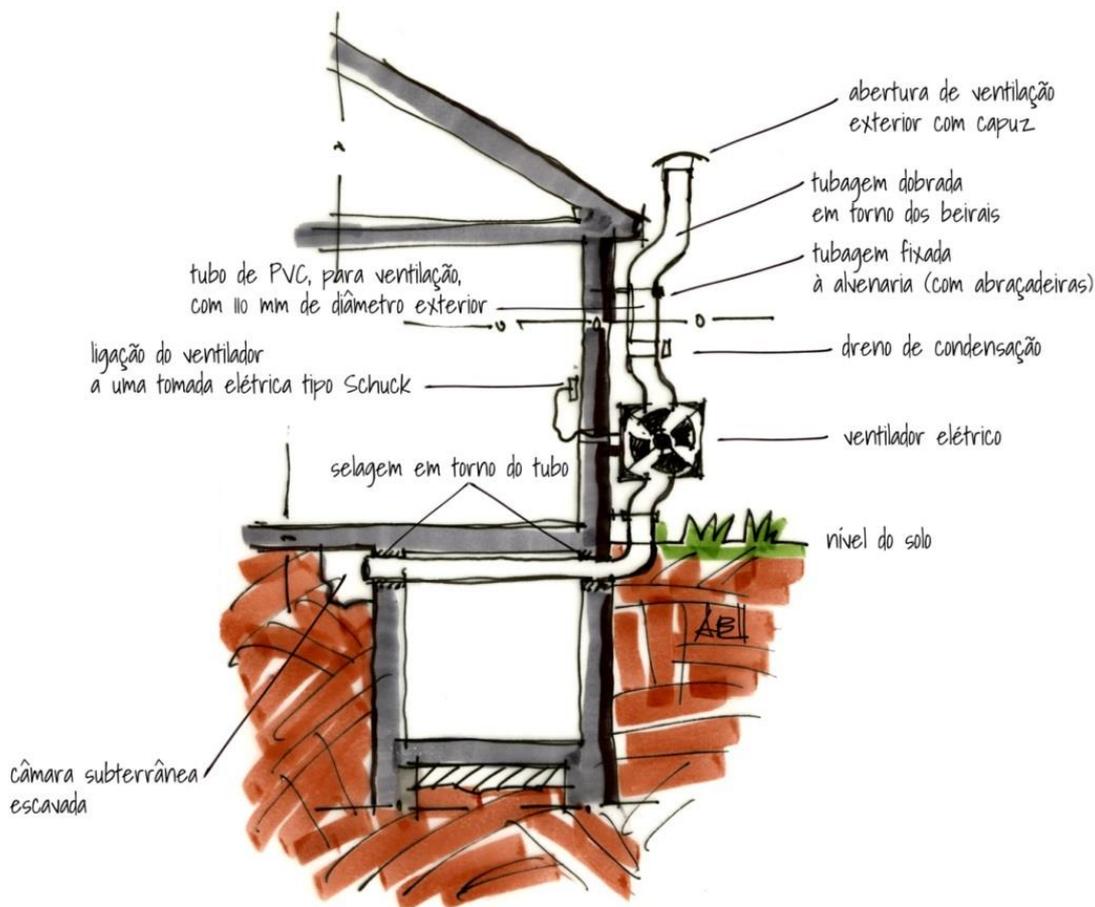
Exemplo de sistema de câmara subterrânea junto a uma parede, com conduta e ventilador localizados no exterior
